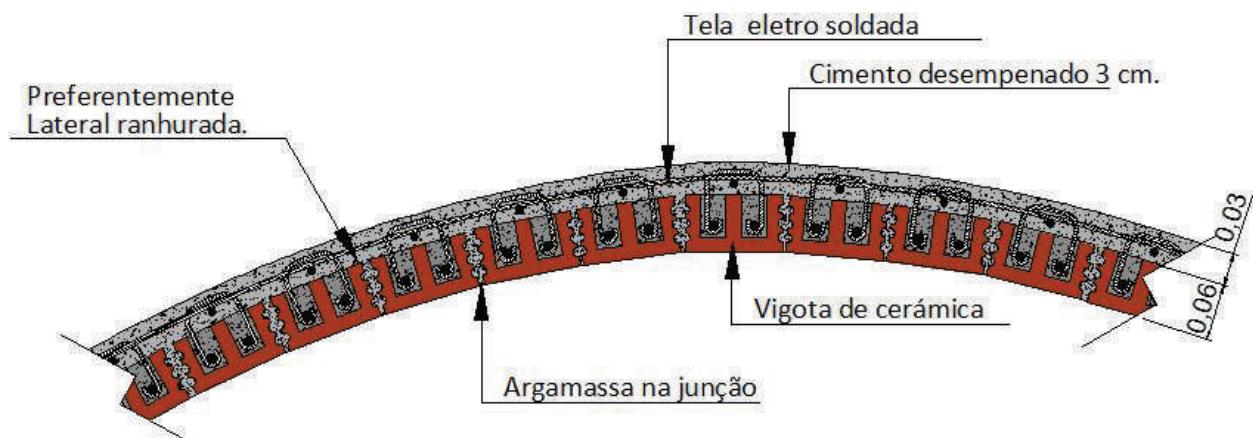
Solução maciça de vigotas e concreto. (*-5).
